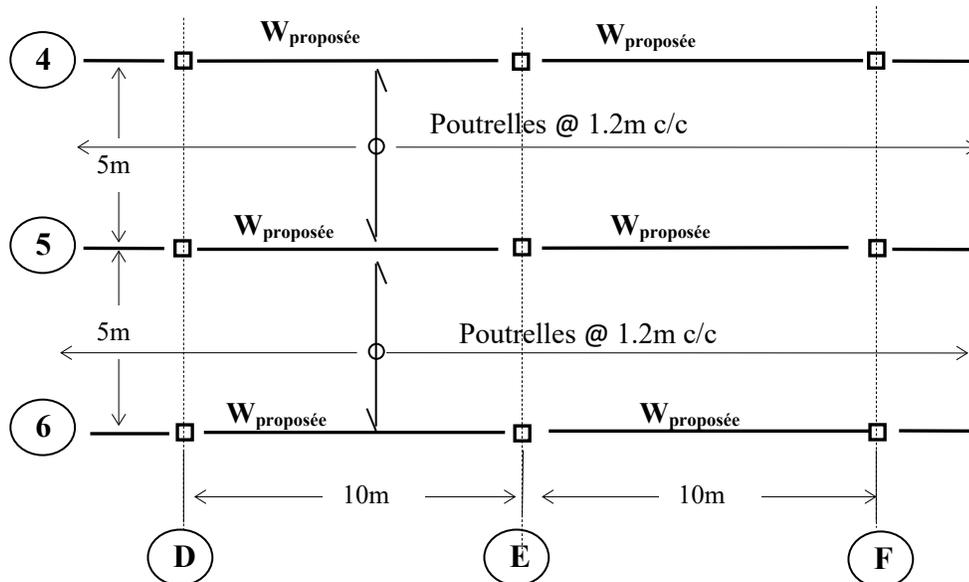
Vue en plan partielle du plancher (pas à l'échelle)
